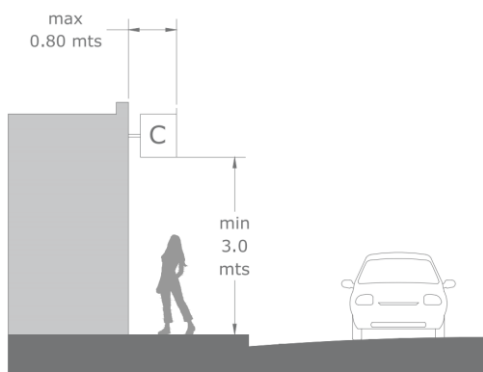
corte esquemático. Fuente: Elaboración propia, 2022
